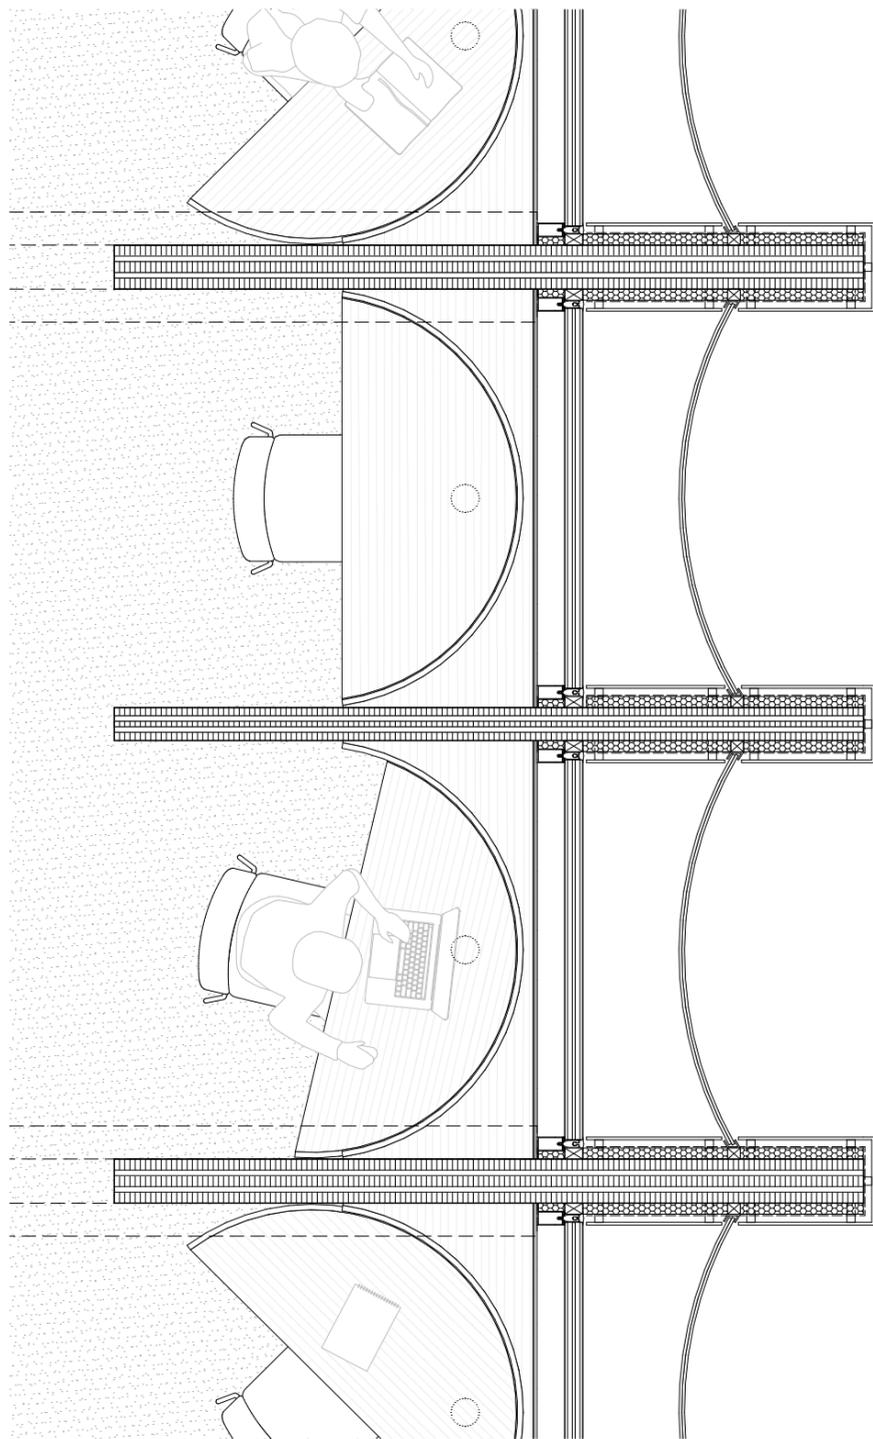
Grundriss Lernkoje, M 1:25
